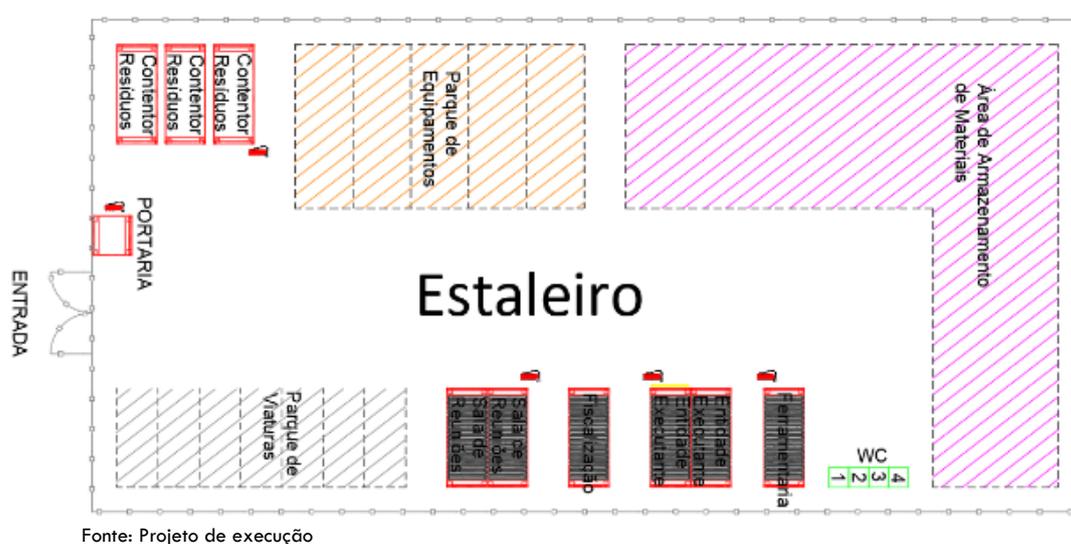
Exemplo da distribuição de um estaleiro tipo em fase de construção
